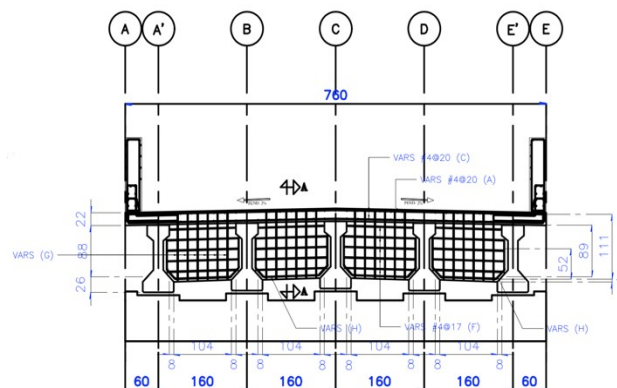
Planta de traveses y cortes transversales de la Superestructura del puente vehicular Tepechicotlán.
